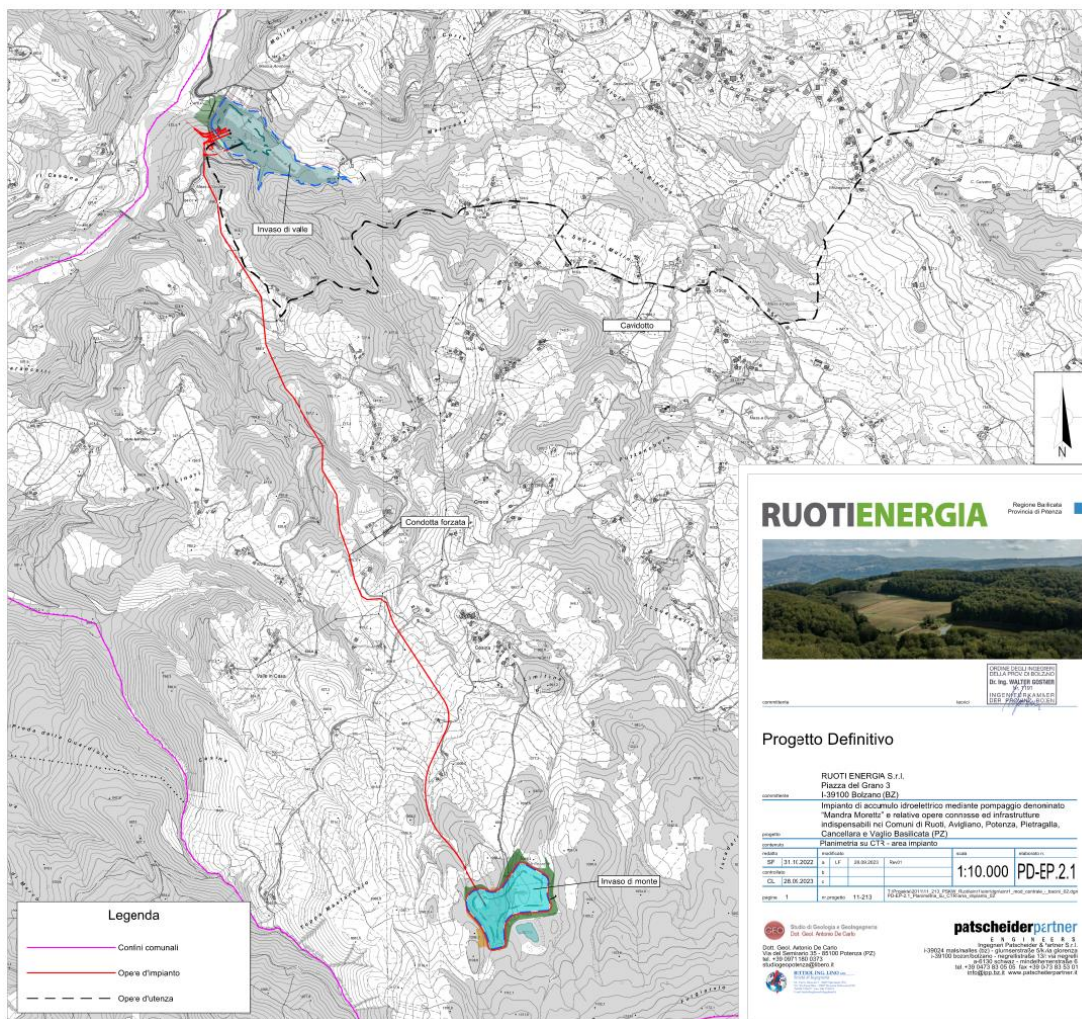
Planimetria su CTR dell'area di impianto (elaborato PD-EP.3.1 del progetto definitivo)
